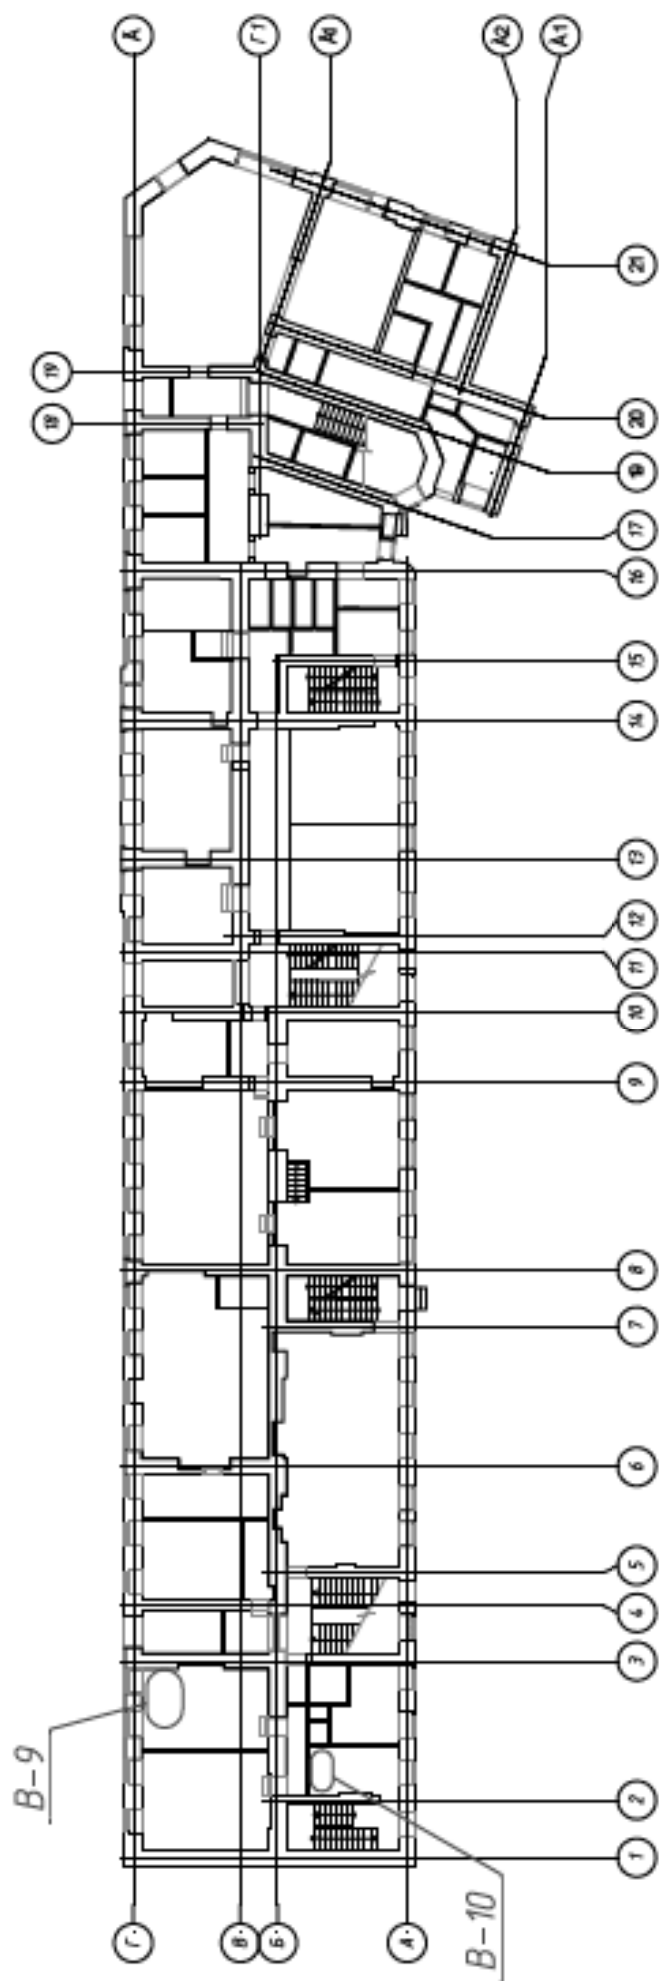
Схема расположения вскрытий 1-го этажа
